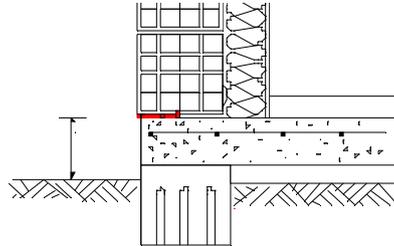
Hauteurs minimales selon DTU 20.1
